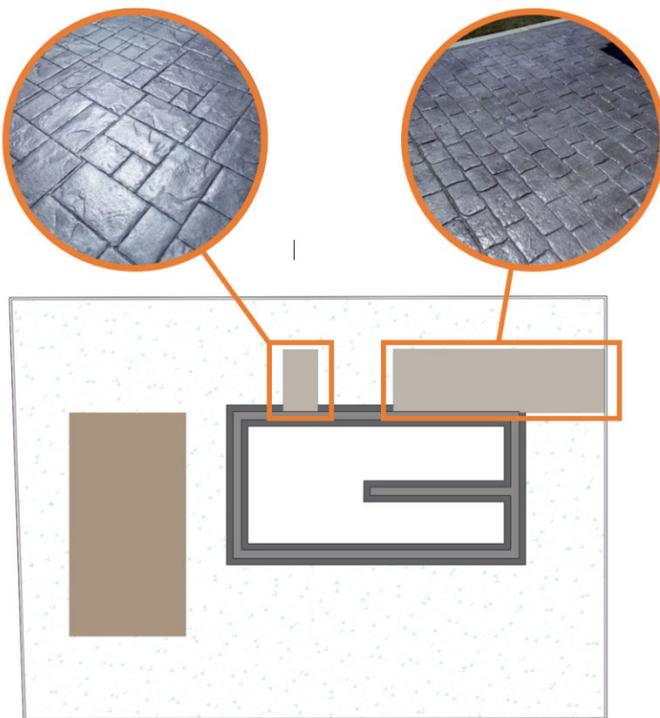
Losas de hormigón impreso en la vivienda. Elaboración propia
